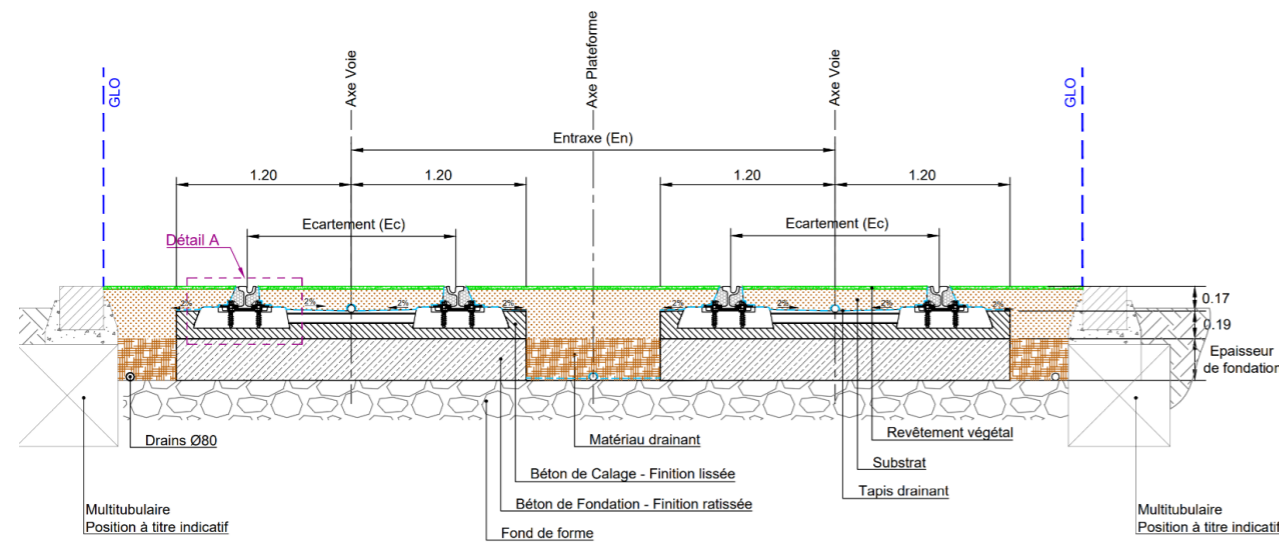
coupe type de plateforme – Voie béton traverses – Revêtement végétal
